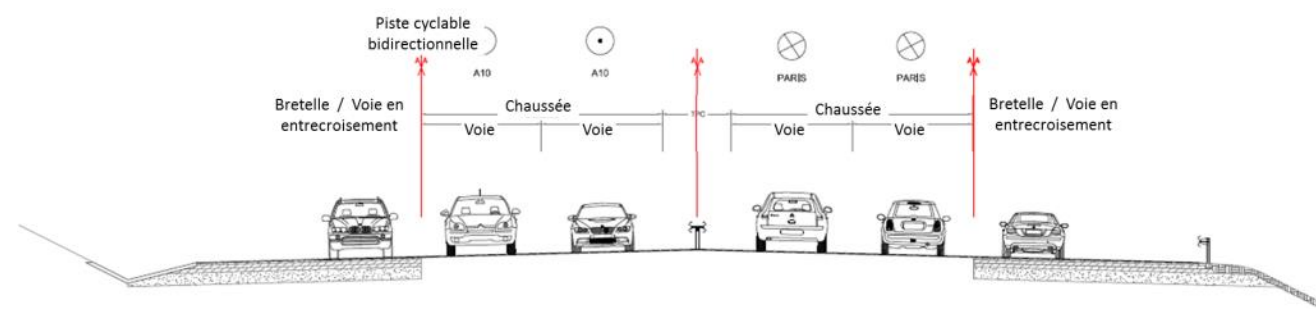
Profil en travers type mis en œuvre sur la section courante (RN 118) au droit de l'insertion des bretelles
